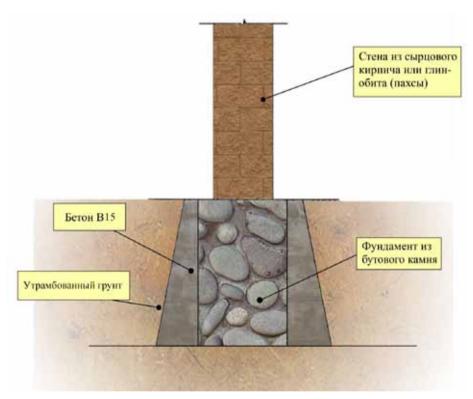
Усиление фундамента из бутового камня путем наращивания сечения фундамента
